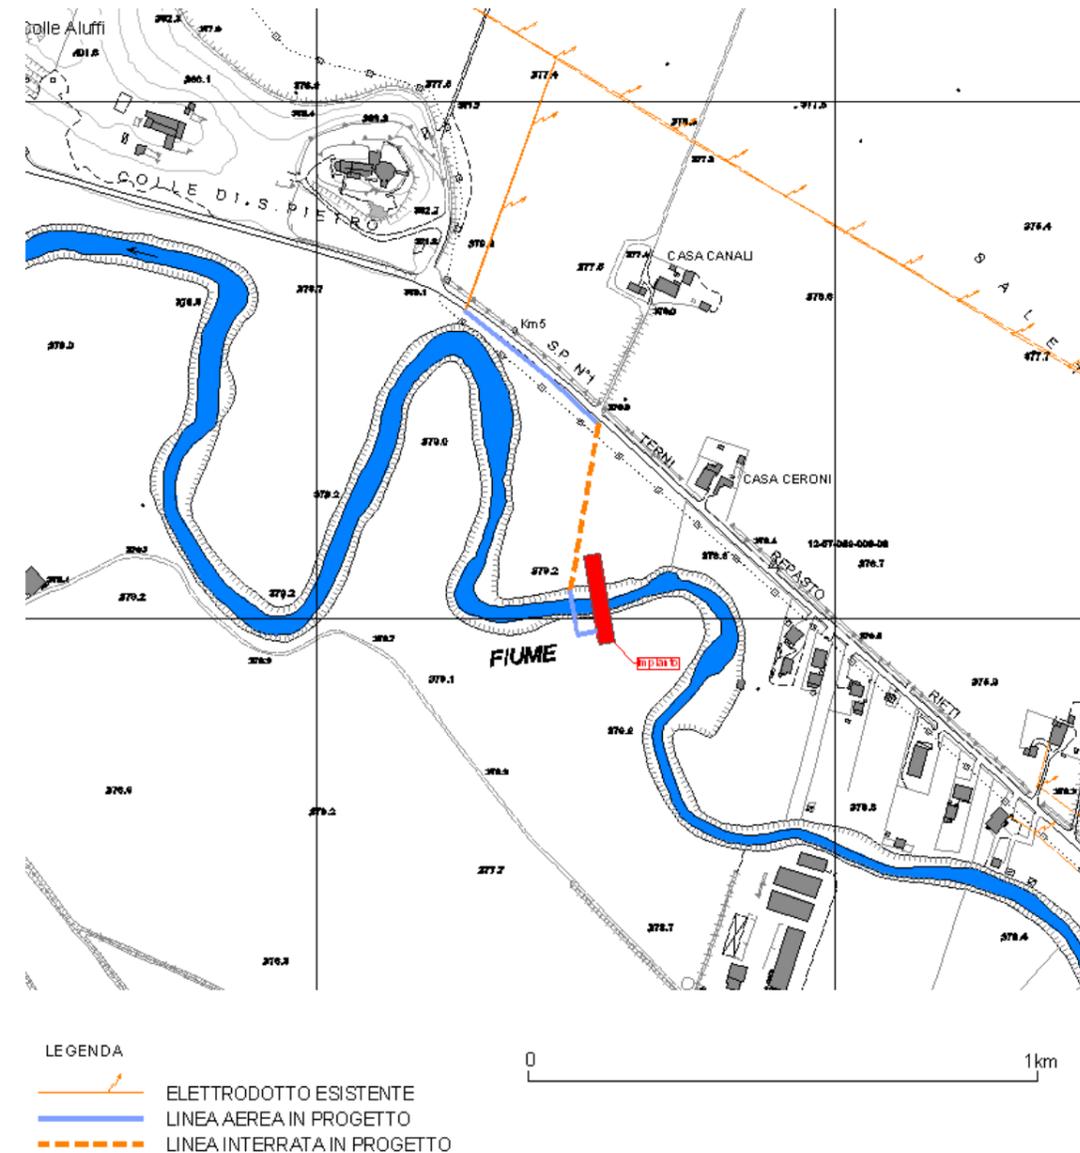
Planimetria della connessione elettrica alla rete esistente – base CTR
